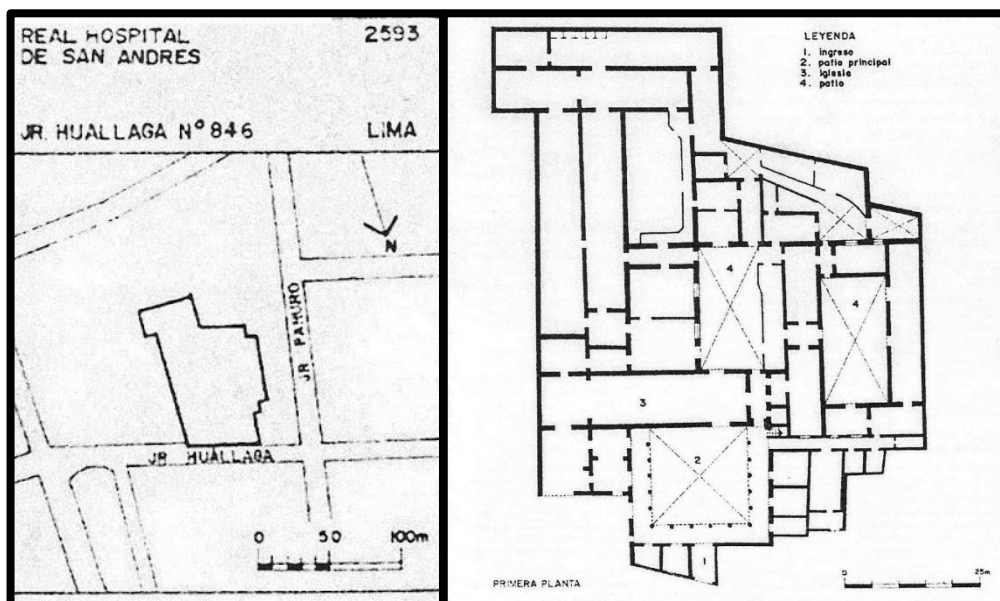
Plano de ubicación y Planta del Hospital de San Andrés
